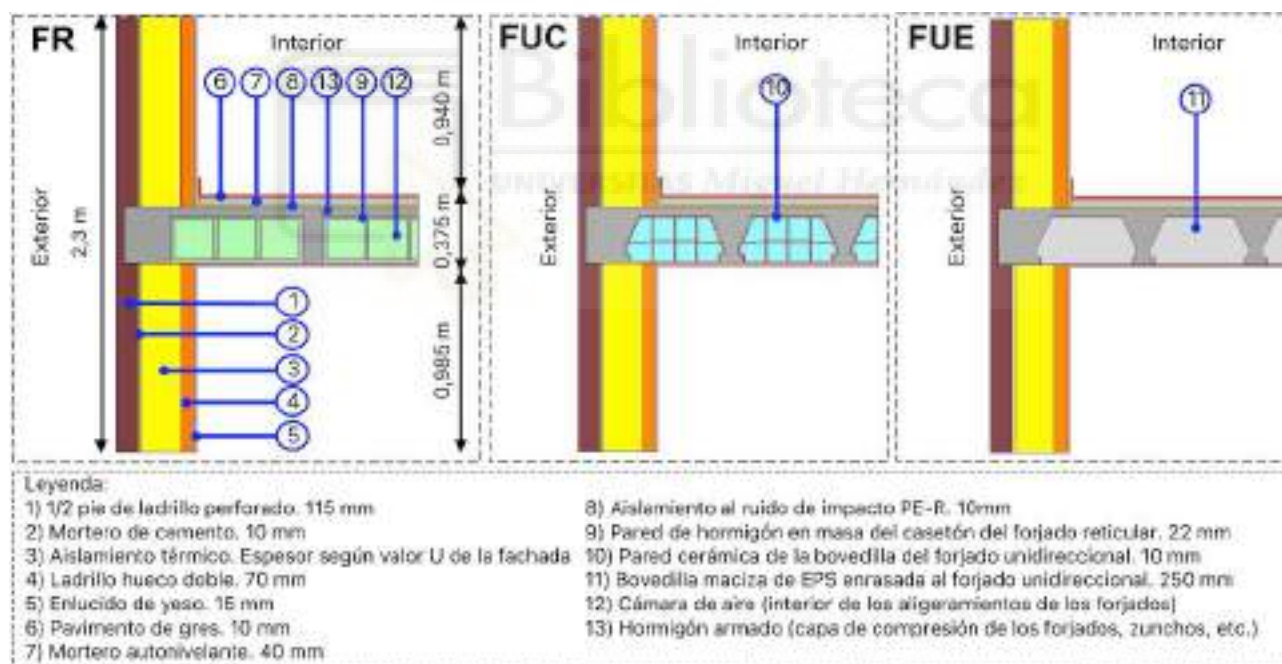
Detalle encuentro de fachadas doble hoja con tres tipos de forjado.
